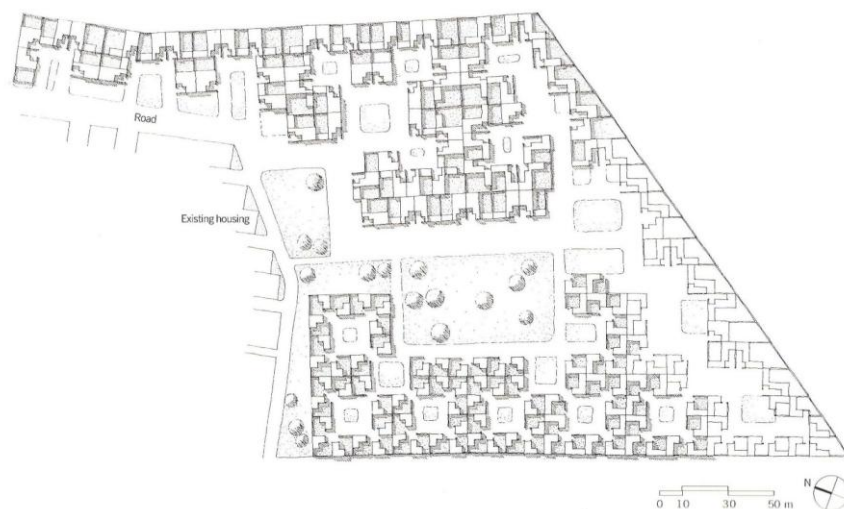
Plano de situación de las tipologías MIG I y MIG II.
